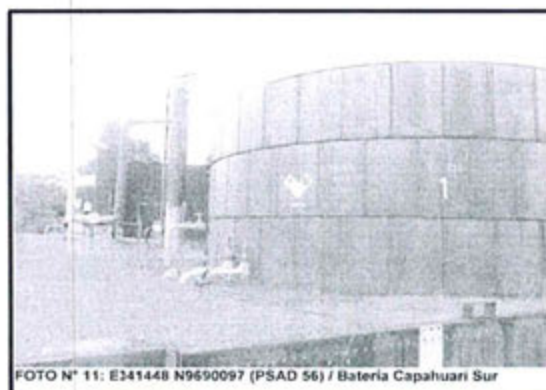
E341448 N9690097 (PSAD 56) / Bateria Capahuari Sur
